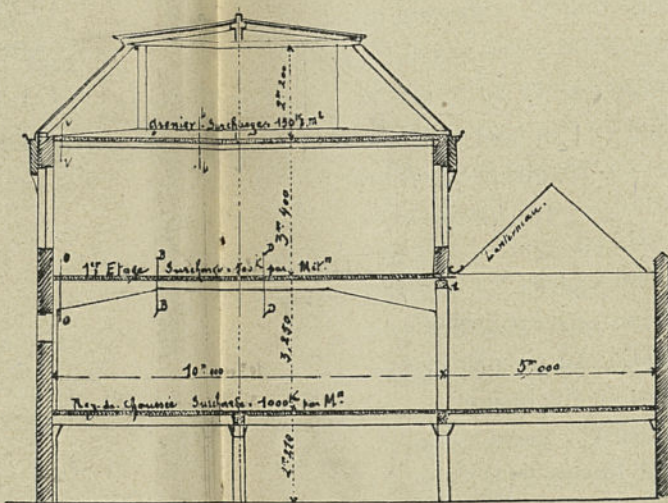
Coupe Transversale (1/2 m de 0.51 par Mètre)
